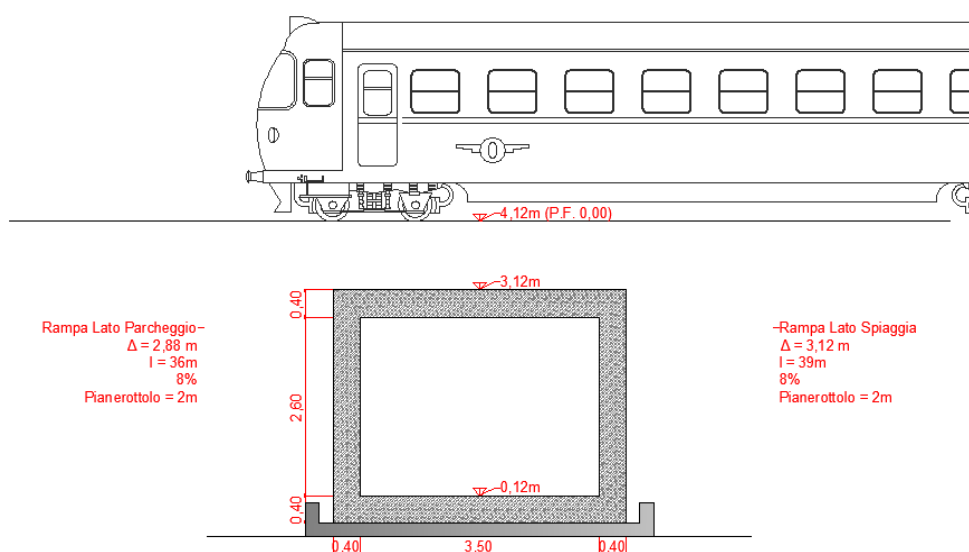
Sezione schematica del sottopasso scatolare in progetto.
